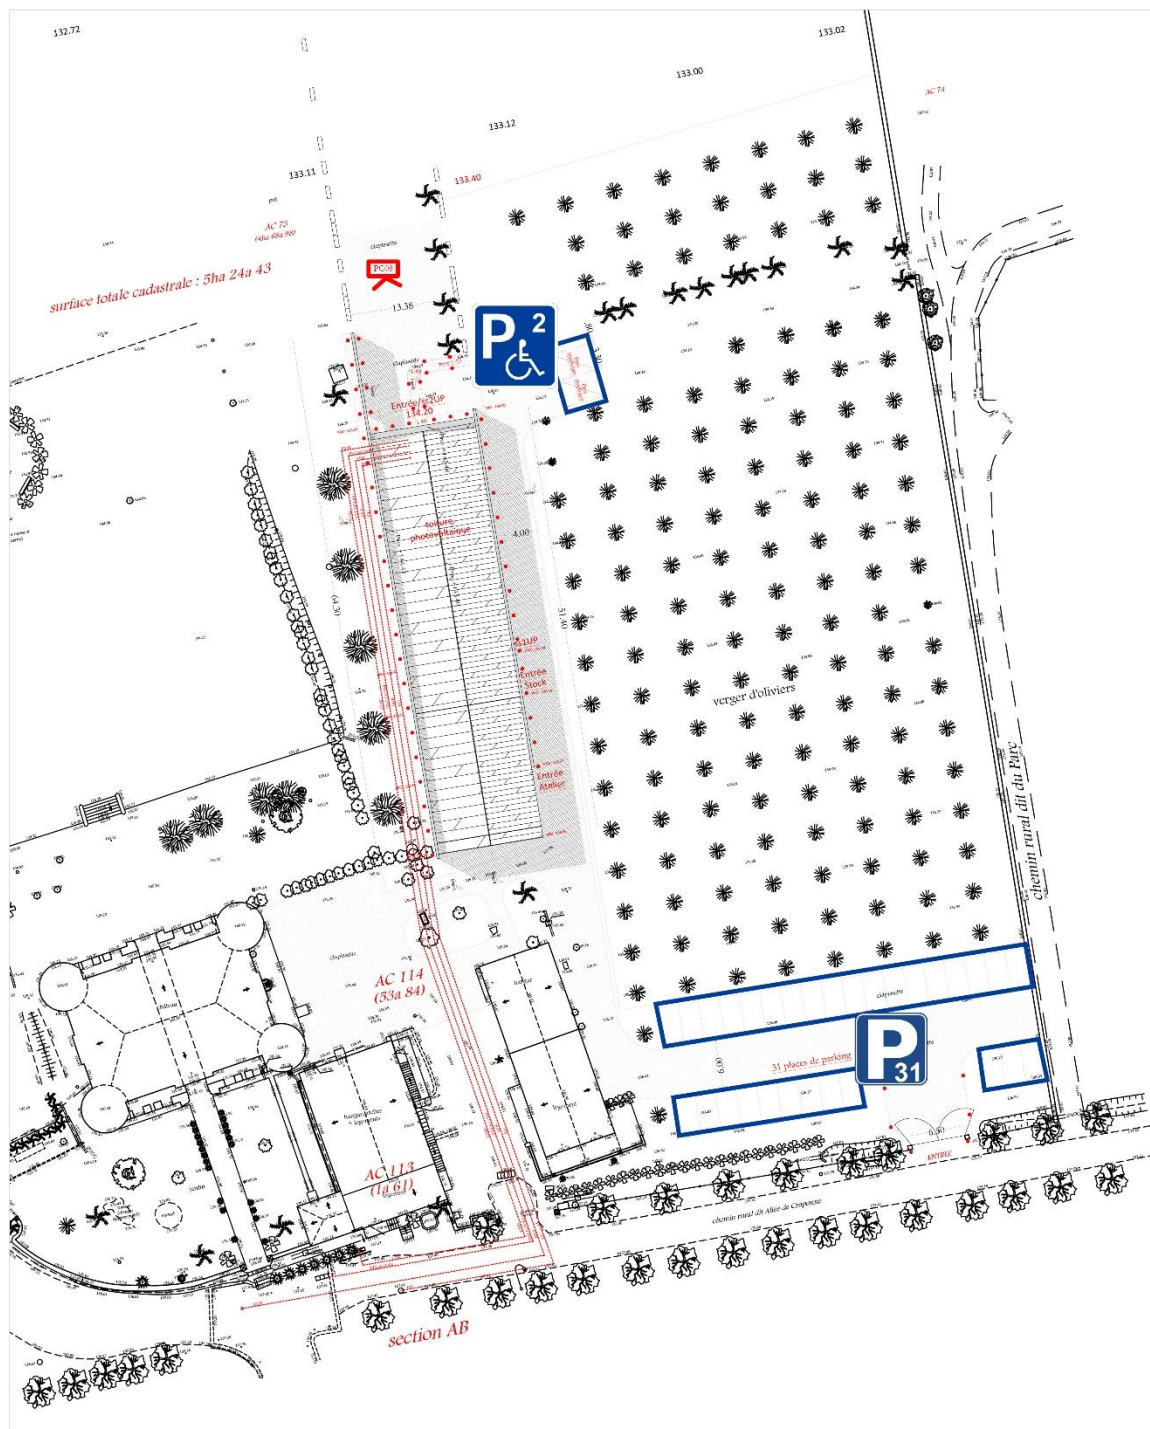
Plan de Masse du projet de Maison des Artistes – Stationnements - Source : BOSC ARCHITECTES
